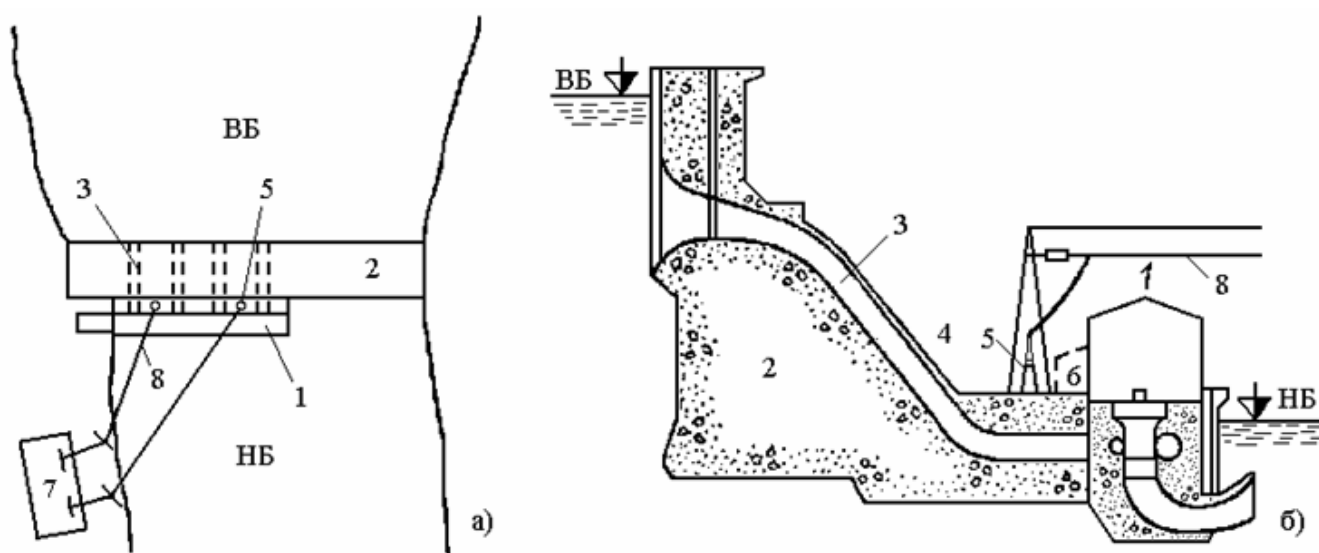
План (а) і поперечний переріз (б) ГЕС, розташованої біля греблі
